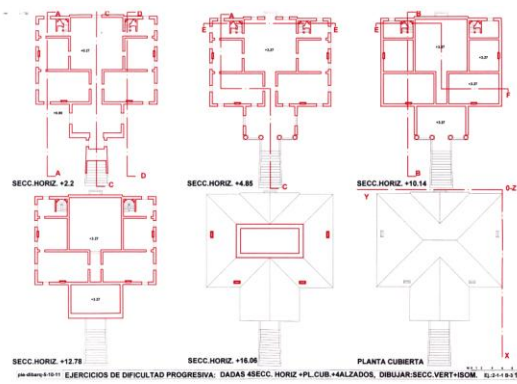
Ej.2-1-1B-3 Secciones horizontales y planta de .cubierta
